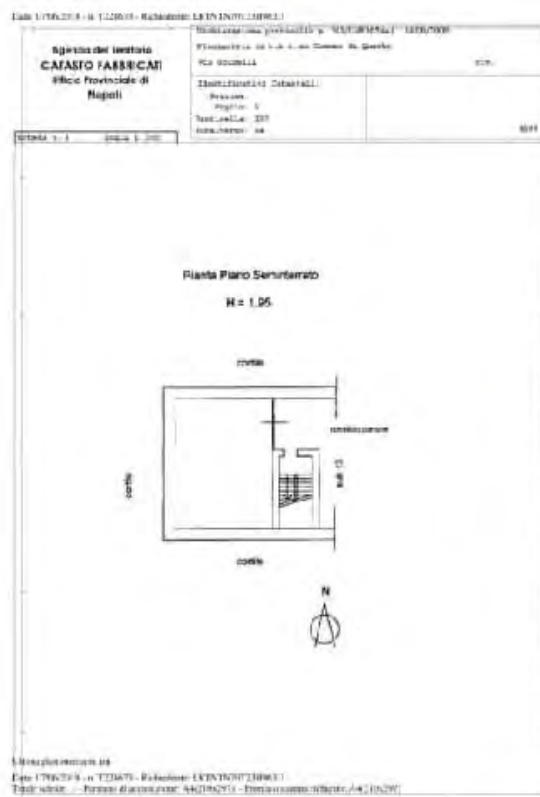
Planimetria catastale locale deposito al piano seminterrato (14.6.2006)
